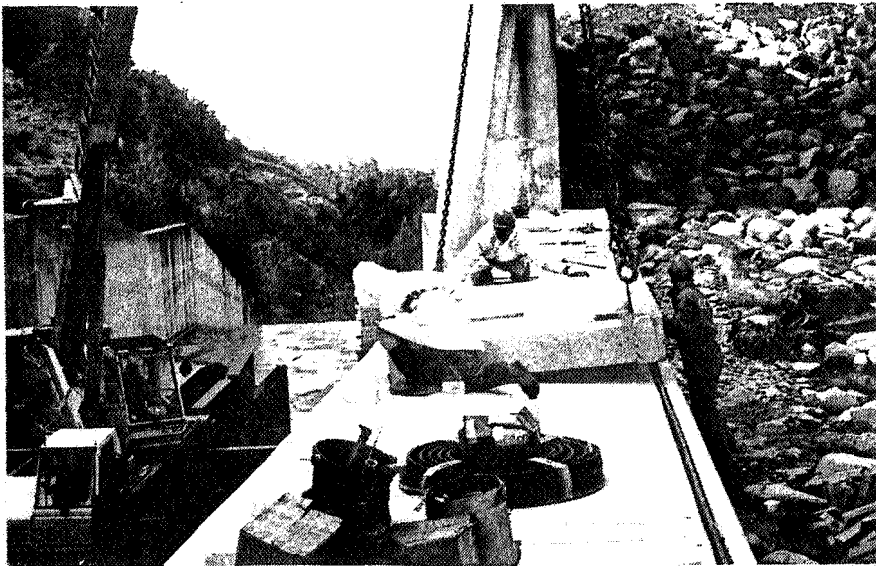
Pose de la base d'une hausse, sur le seuil restauré. Remarquer, à gauche, les butées et, à droite, le joint longitudinal dans sa rainure (CEMAGREF Aix-en-Provence)
